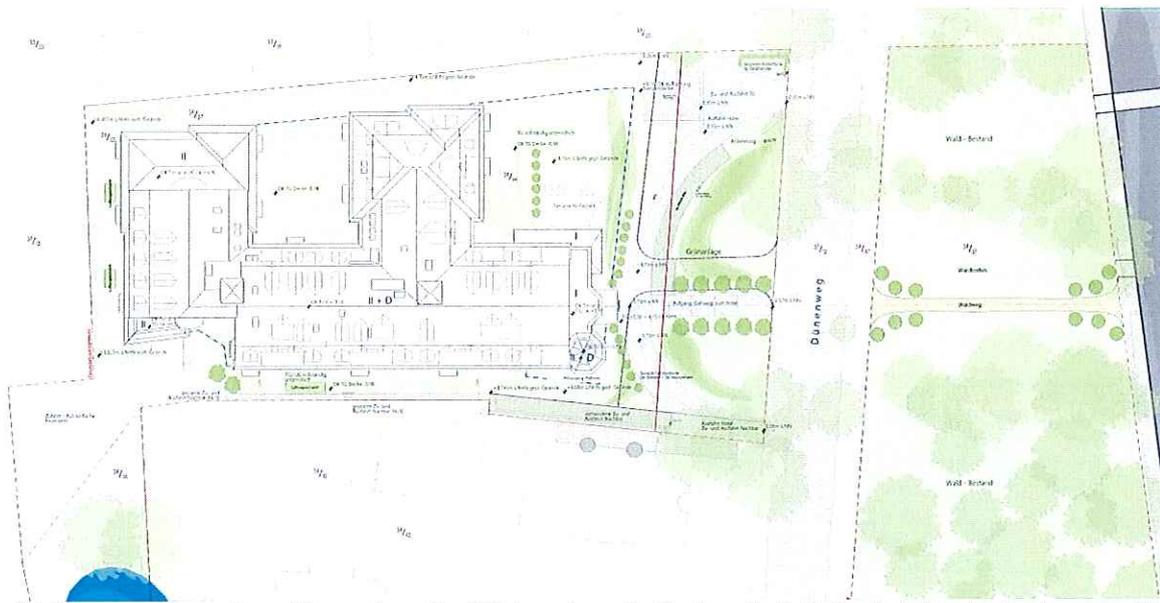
Lageplan. Allgemeiner Freiflächenplan. Baltischer Hof, Suitenhotel in Boltenhagen. Architekt: Planungsgruppe Gieseke, Kühlungsborn und Pohl Architektur, Berlin. Stand Mai 2018
